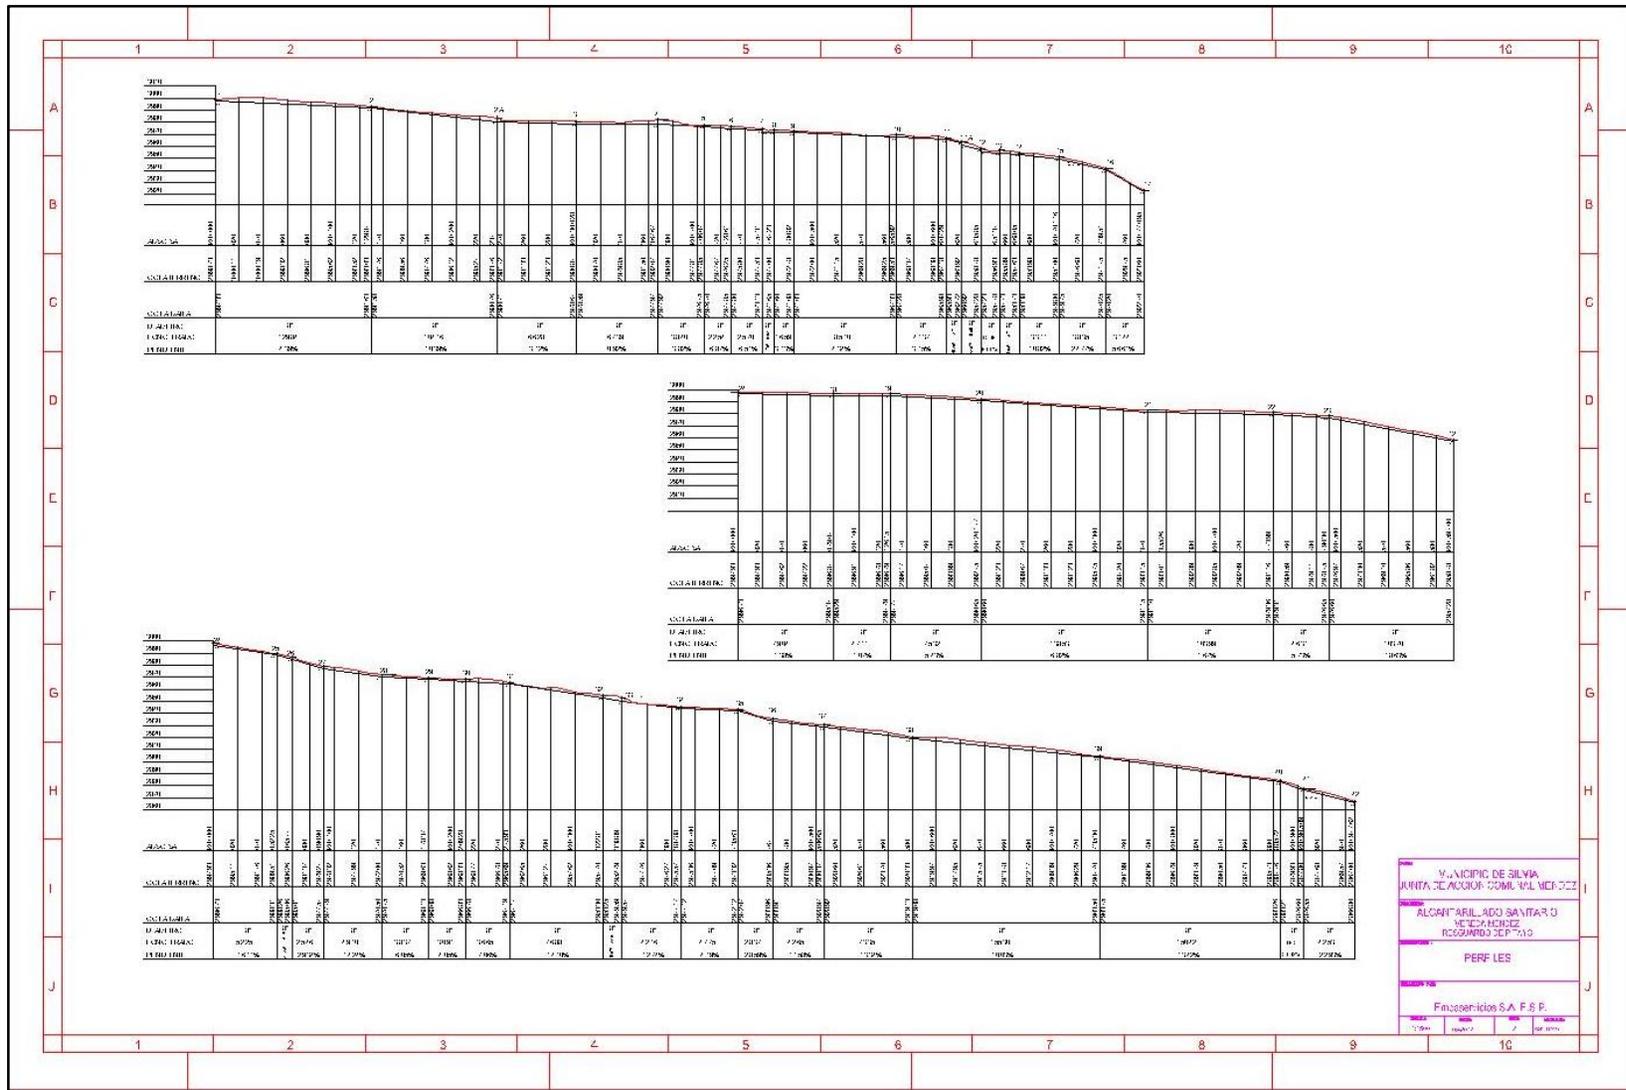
Plano perfiles, Alcantarillado sanitario, vereda Méndez – Pitayó
